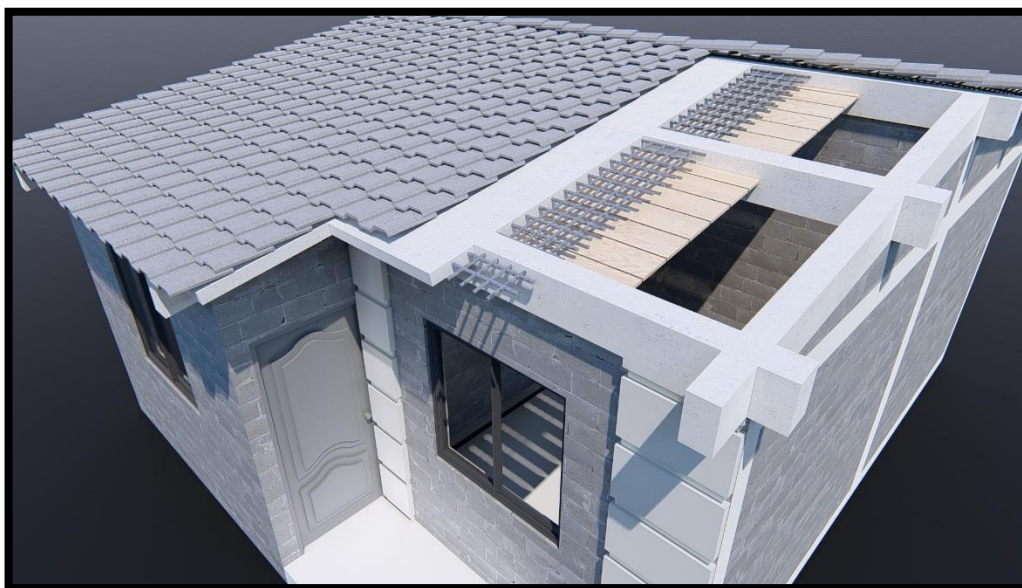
Rrender de losa maciza y vigas de hormigón
